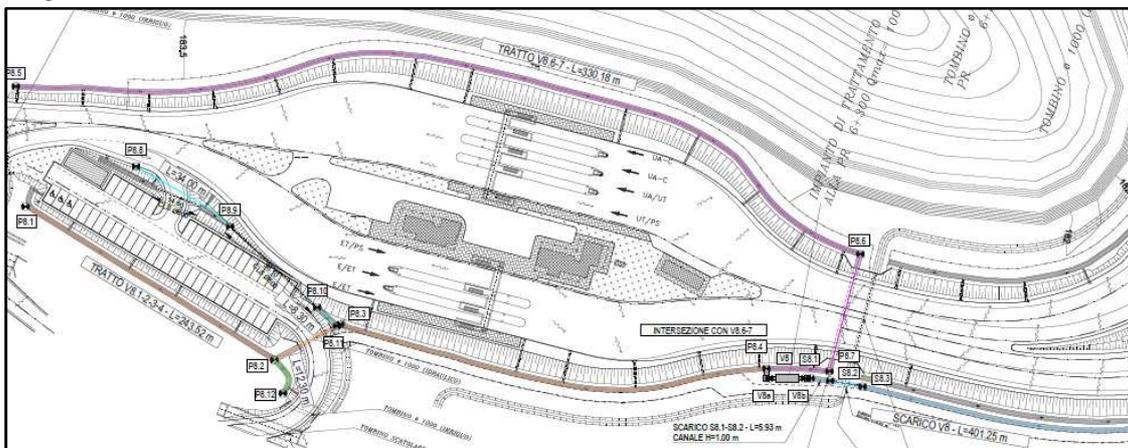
Stralcio Planimetria punti singoli (elaborato 2.6E-dC.4.3.8.02-00)
